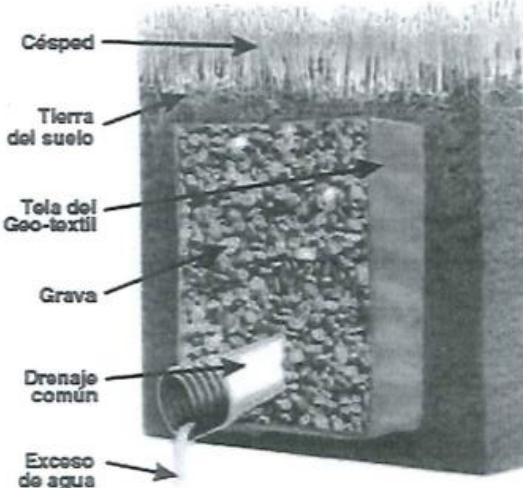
Detalle típico de drenaje francés (Fuente: <https://www.pinterest.com.mx>)
